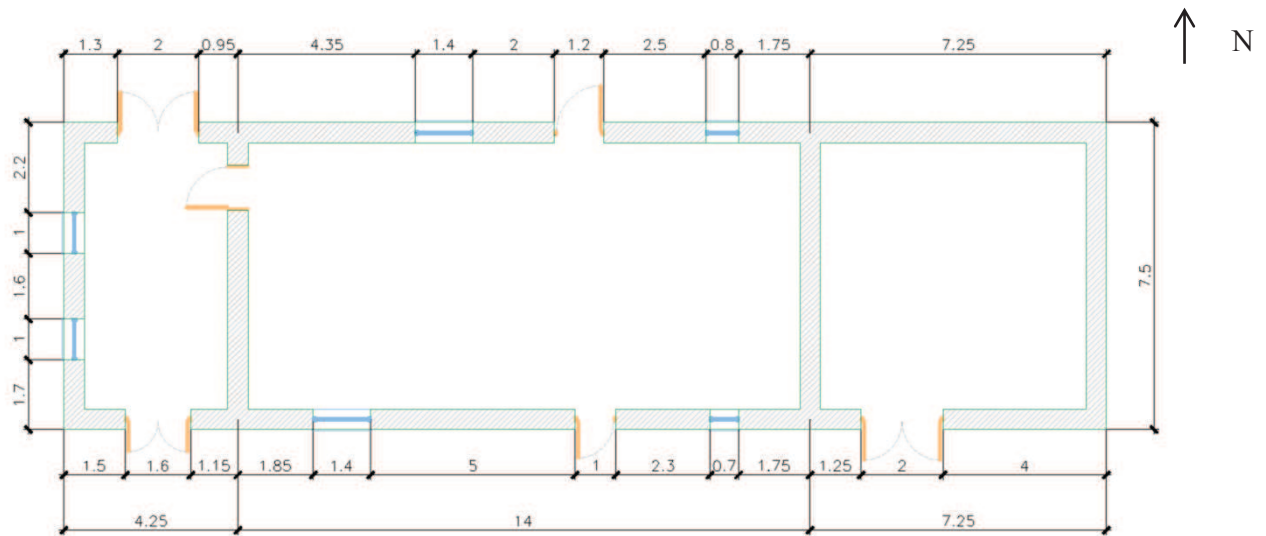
Plan du rez-de-chaussée du cas d'étude
